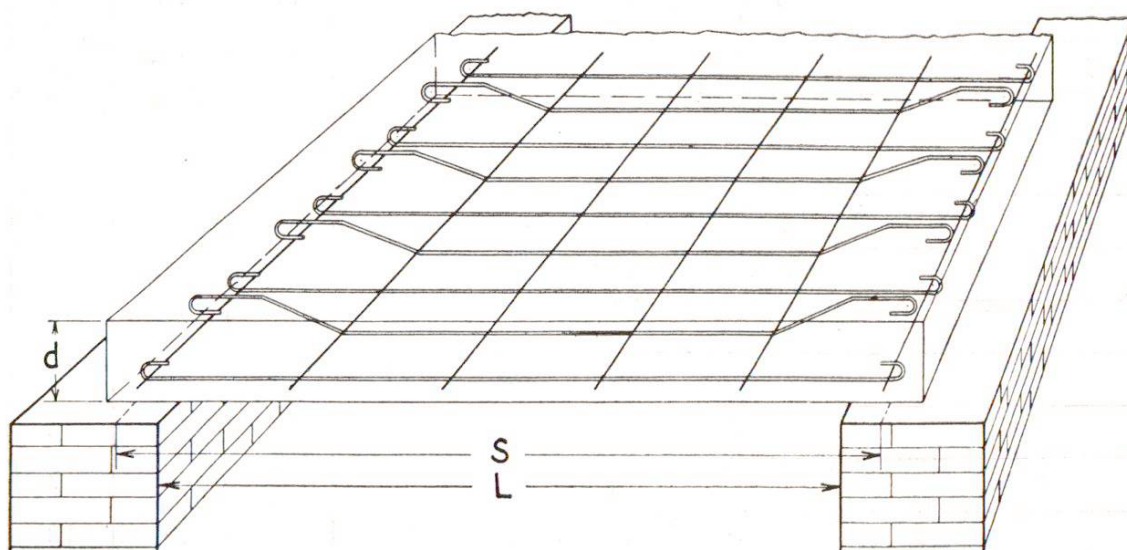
Croquis en perspective d'une dalle pleine sur appuis simples. (L = ouverture libre, S = portée, d = épaisseur de la dalle)
